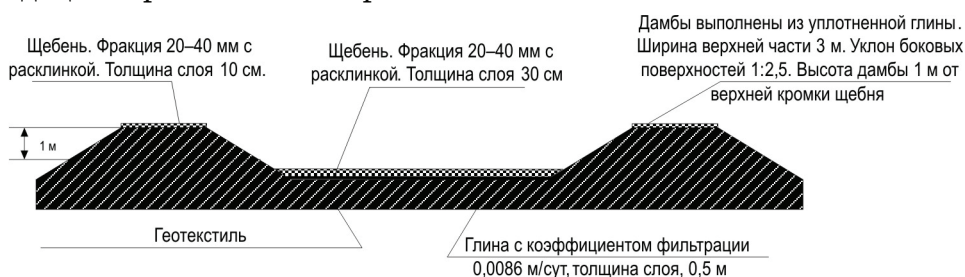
Схема исполнения гидроизоляционного экрана площадки временного хранения донных отложений
